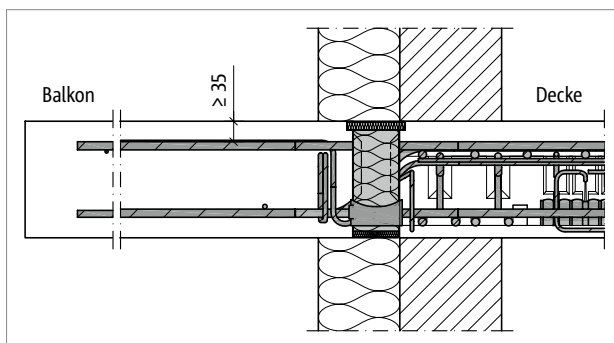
Schöck Isokorb® T Typ C: Schnitt 1. Lage; Anschluss bei Wärmedämmverbundsystem (WDVS)
